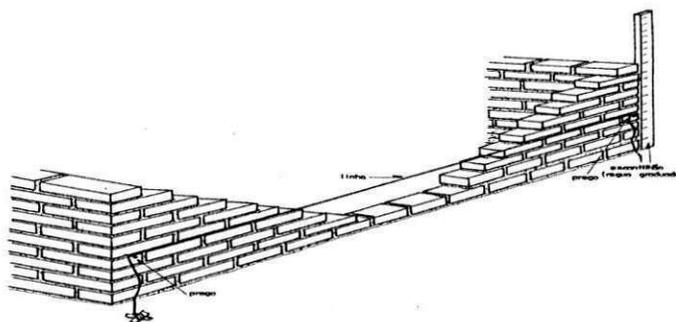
Detalhe do nivelamento da elevação da alvenaria
